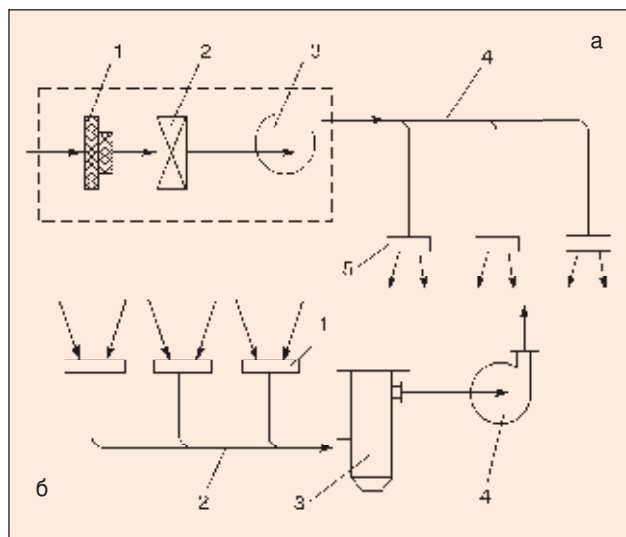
Схемы механической вентиляции: а — приточной (1 — пылеочистительный фильтр; 2 — калорифер; 3 — вентилятор; 4 — магистральный воздухопровод; 5 — вентиляционные нагнетательные насадки); б — вытяжной (1 — вентиляционные заборные насадки; 2 — магистральный воздухопровод; 3 — очиститель загрязненного воздуха; 4 — вентилятор)
